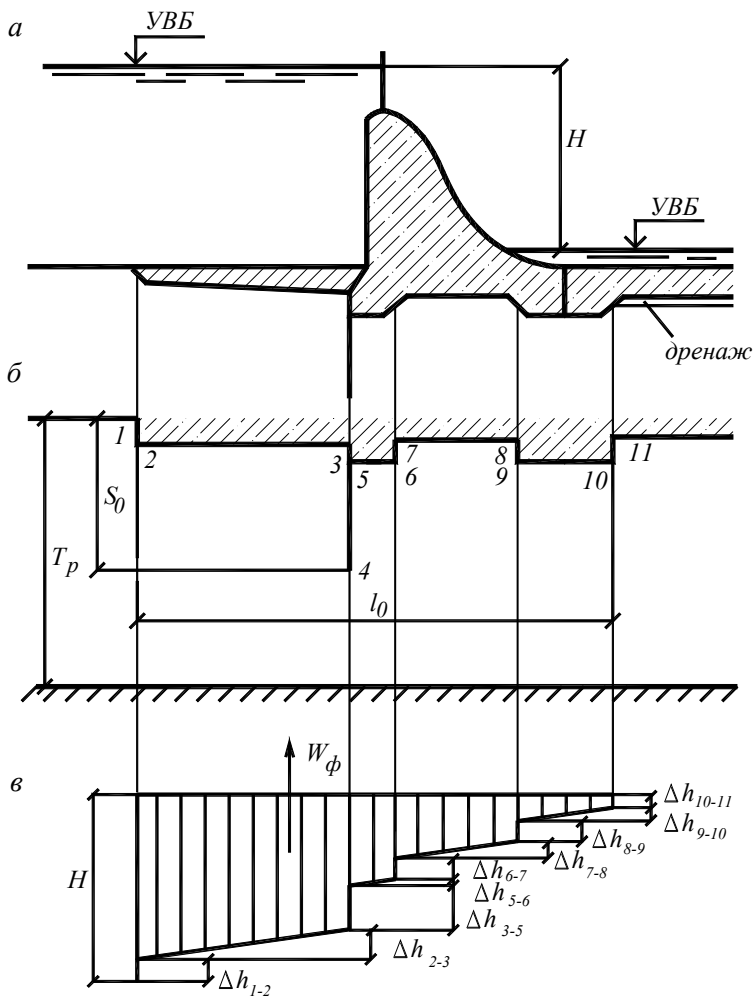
Схема к расчету фильтрации в основании бетонной плотины:
